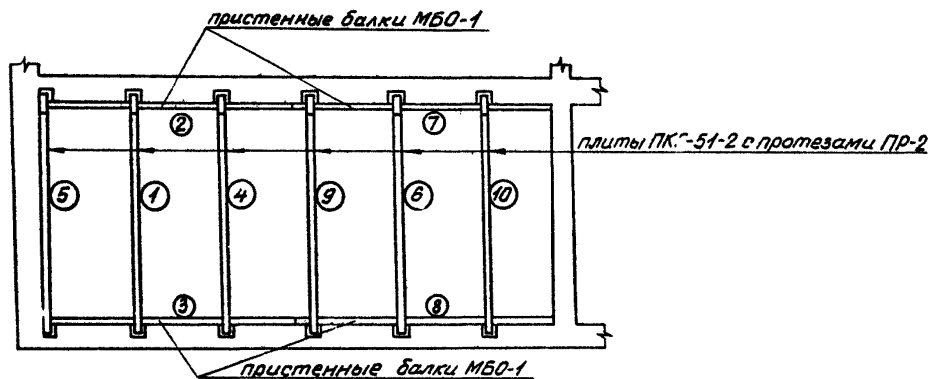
Последовательность монтажа плит ПКГ-51-2 с протезами ПР-2 и пристенных балок МБ0-1.
